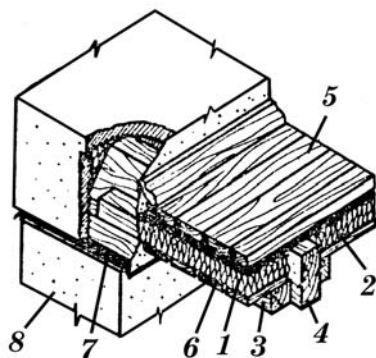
Конструктивные узлы соединения цокольного перекрытия с «черным» полом по черепным брускам: 1 – утеплитель; 2 – пароизоляция; 3 – балка; 4 – черепной брусок; 5 – доски пола; 6 – «черный» пол (подшивка); 7 – гидроизоляция; 8 – цоколь.
